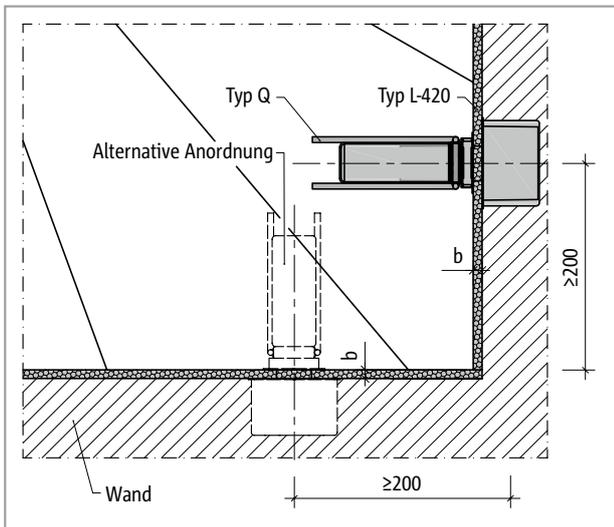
Schöck Tronsole® Typ Q: Elementanordnung, Detail A, Fugenbreite $b = 15 \text{ mm}$ bei Ortbeton, bei Fertigteiltreppenläufen ist die Notwendigkeit einer zusätzlichen Einbautoleranz durch den Planer zu prüfen
